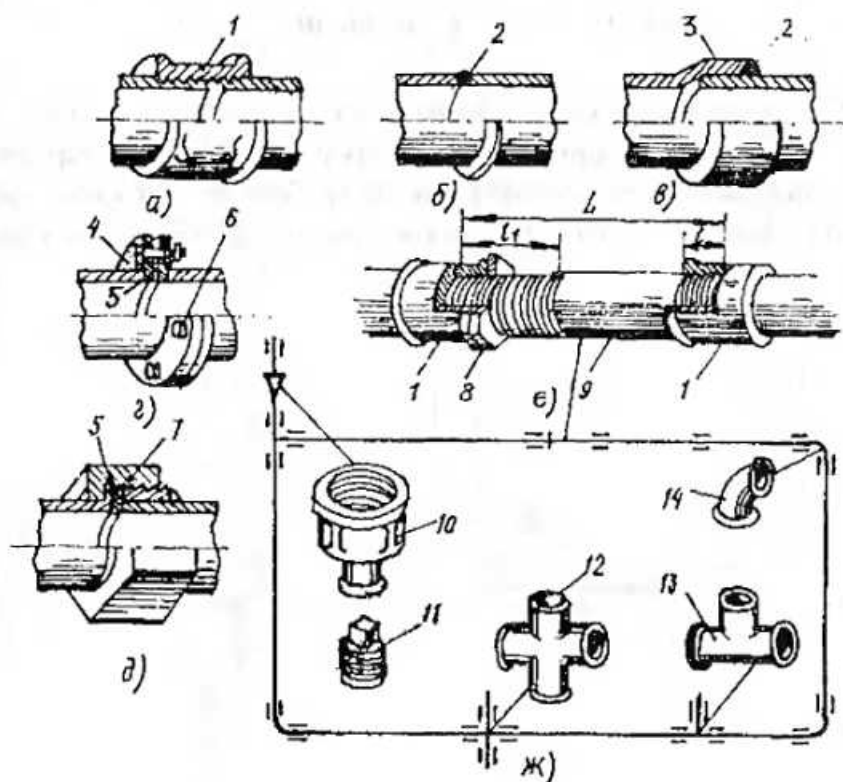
Види з'єднання труб і з'єднувальні деталі: а) різьбове; б) зварне впритул; в) зварне врозтруб; г) фланцеве; д) накидною гайкою; е) згін; ж) з'єднувальні деталі; 1 - муфта; 2 - зварний шов; 3 - розтруб; 4 - фланець; 5 - ущільнювальна прокладка; 6 - болт з гайкою; 7 - накидна гайка; 8 - контргайка; 9 - згін; 10 - перехідна муфта; 11 - пробка; 12 - хрестовина; 13 - трійник; 14 - кутник
